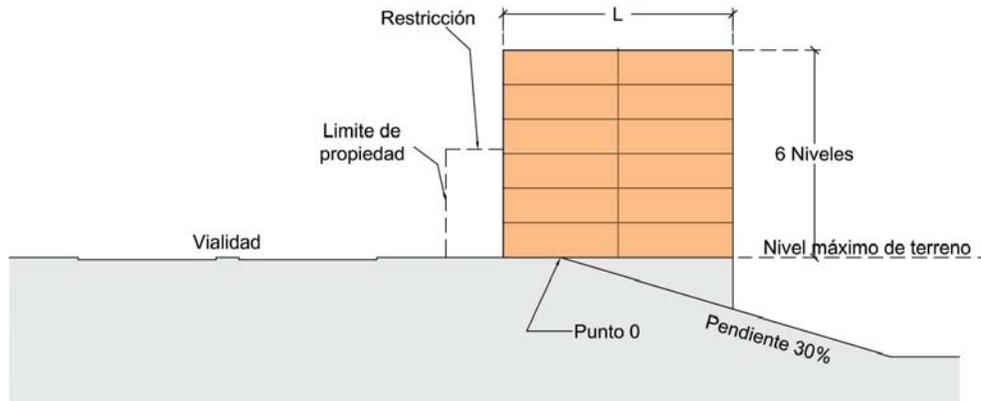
Desplante con terreno plano y pendiente descendente.
